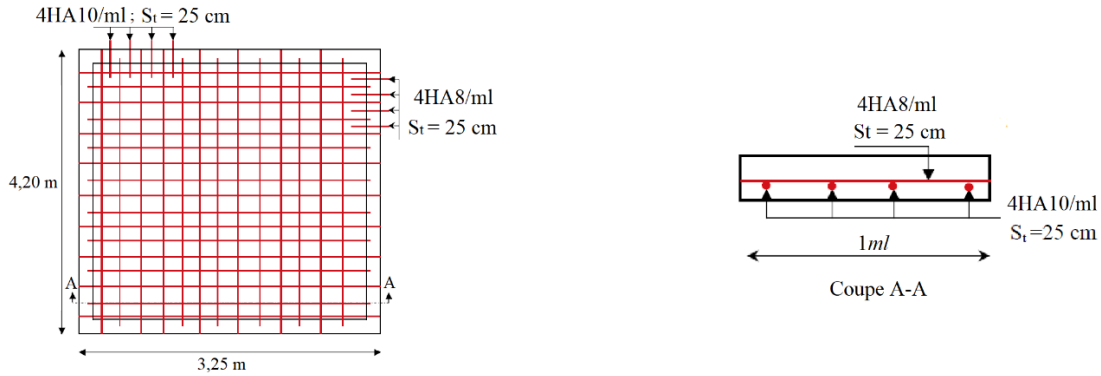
Schéma de ferrailage de la dalle pleine C4 avec la coupe A-A
